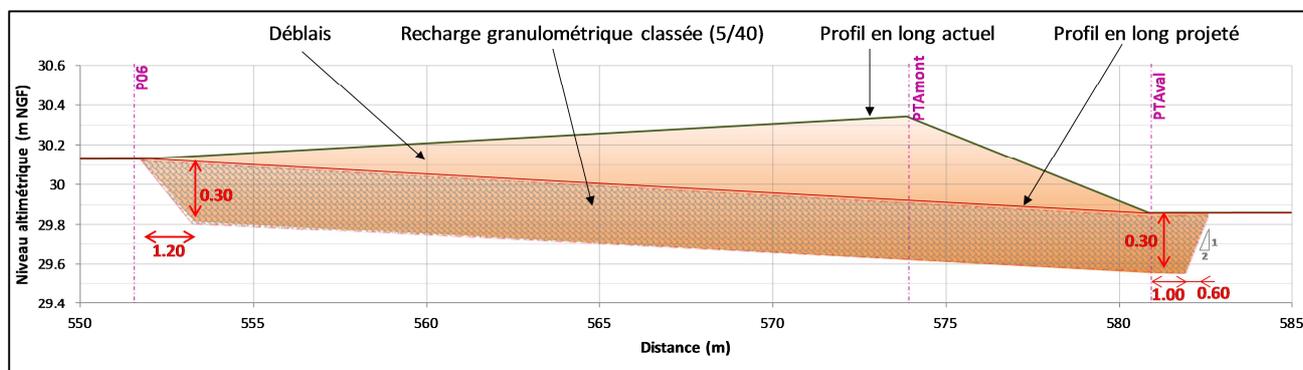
Schéma de principe de la reprise du profil en long au droit du seuil et de la restauration du matelas alluvial
